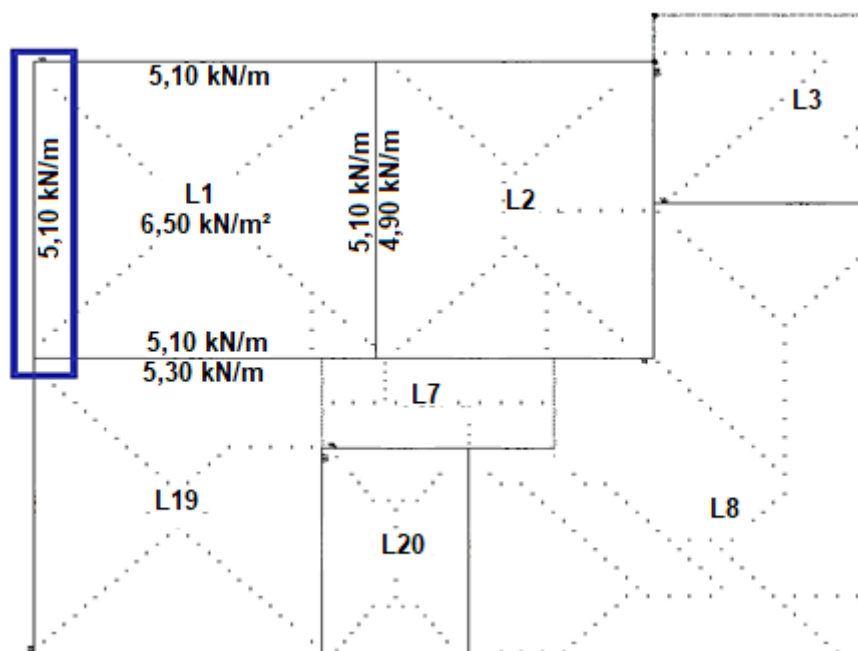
Distribuição das cargas da laje do pavimento cobertura.
